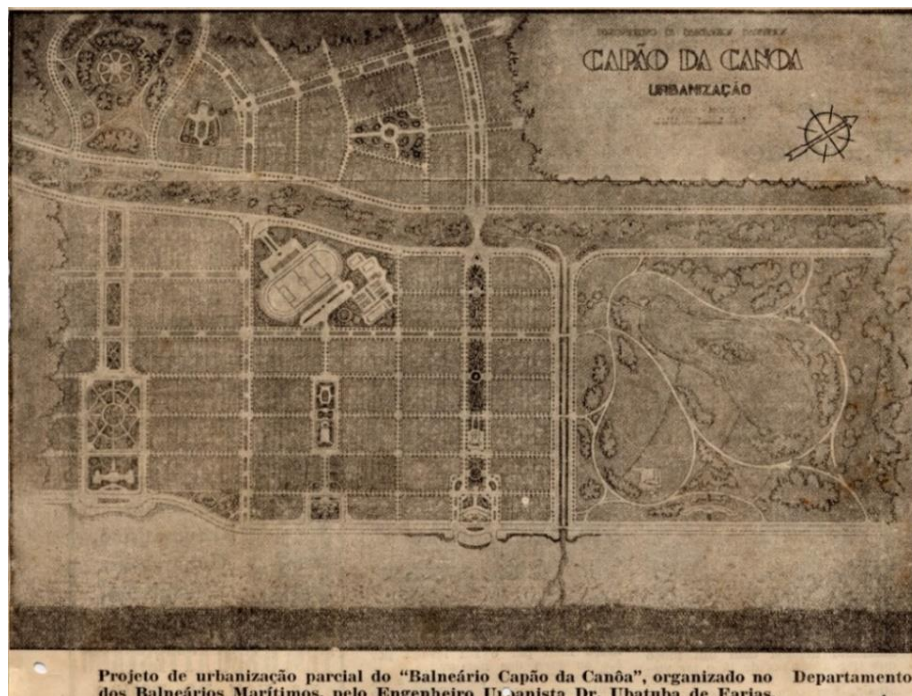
Planta da urbanização parcial de Capão da Canoa, 1942
